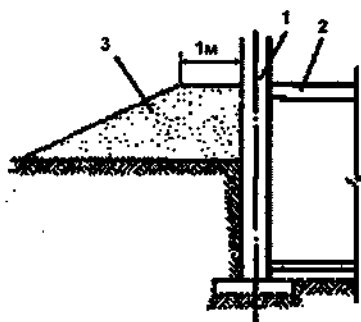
Обсыпка грунтом полуподвальных помещений: 1 – стена; 2 – перекрытие; 3 – обсыпка
